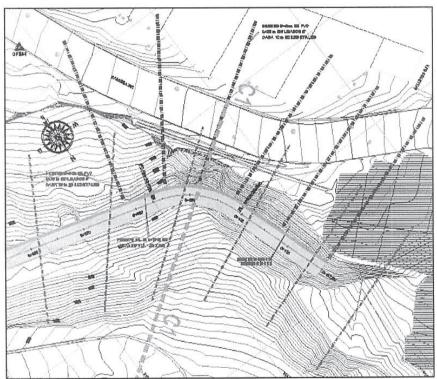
Brisas del Volador- Planta Obras de Contención- Absc 78.52m a 117.35m
